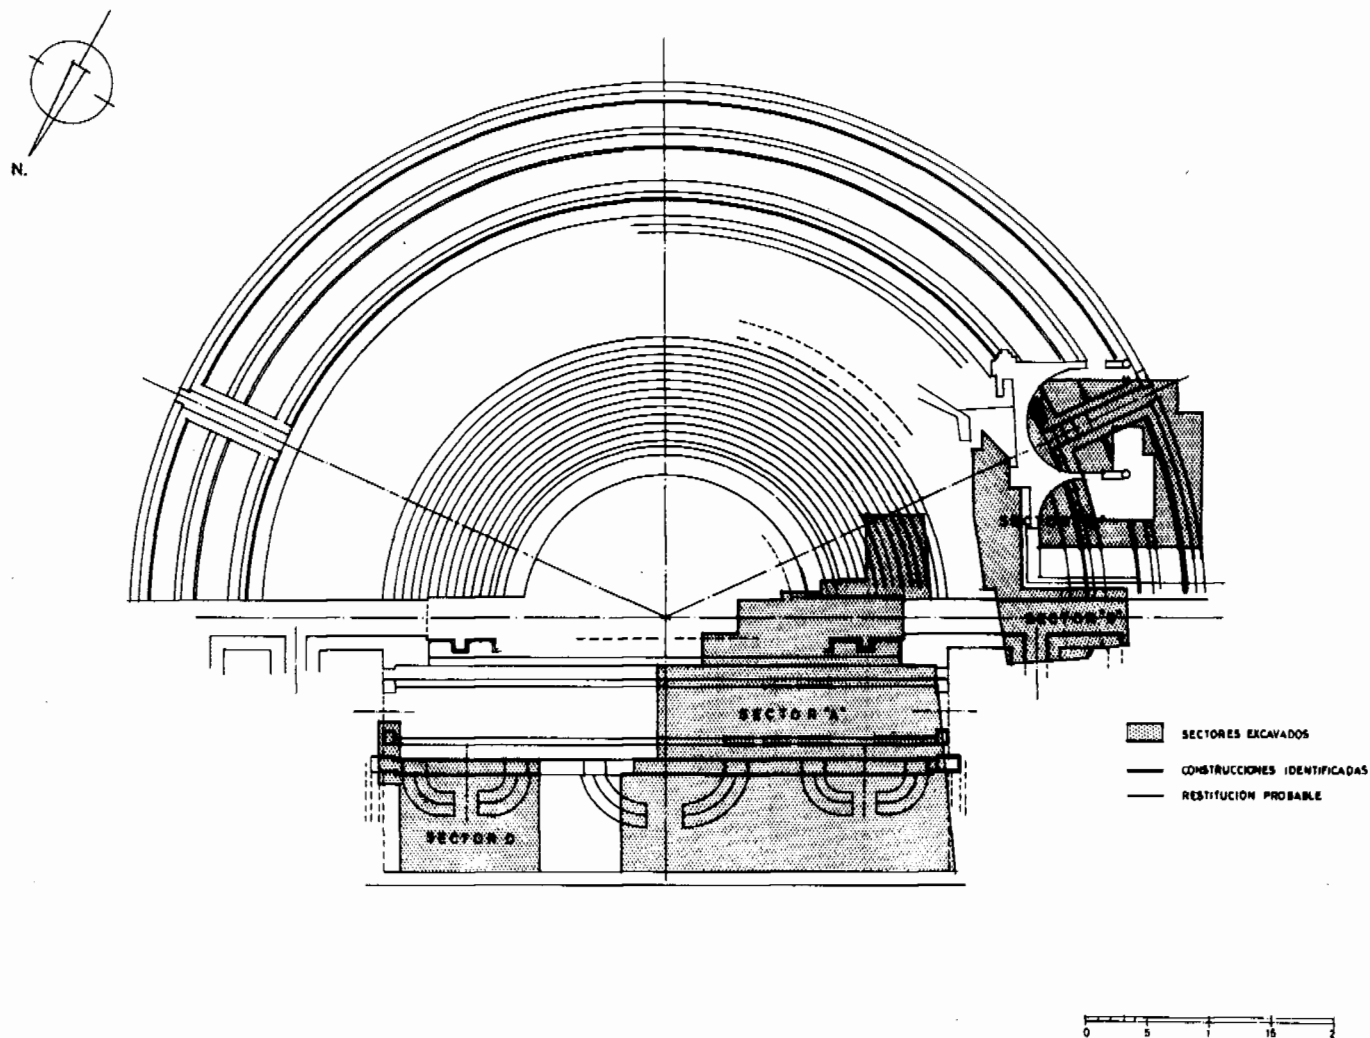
Planta general con los sectores excavados. En línea gruesa, los trazados identificados. En línea fina los restituidos.
